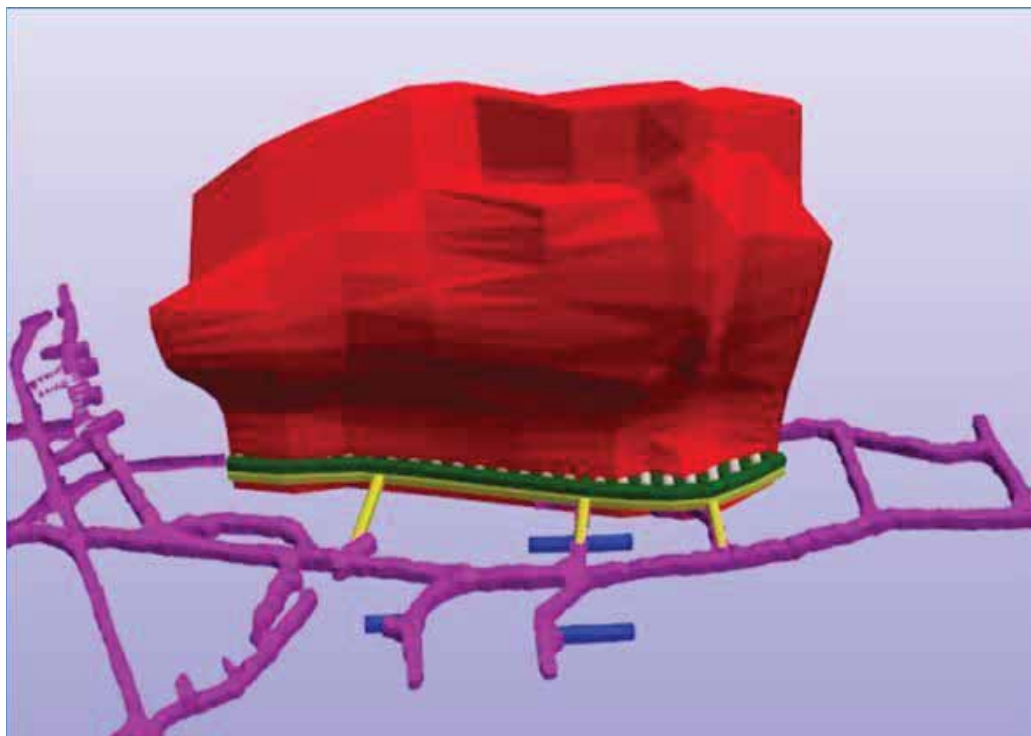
Rampa (-) para el minado de la primera fase. Fuente: Archivo del área de Ingeniería, planeamiento y proyectos-PASHSA
